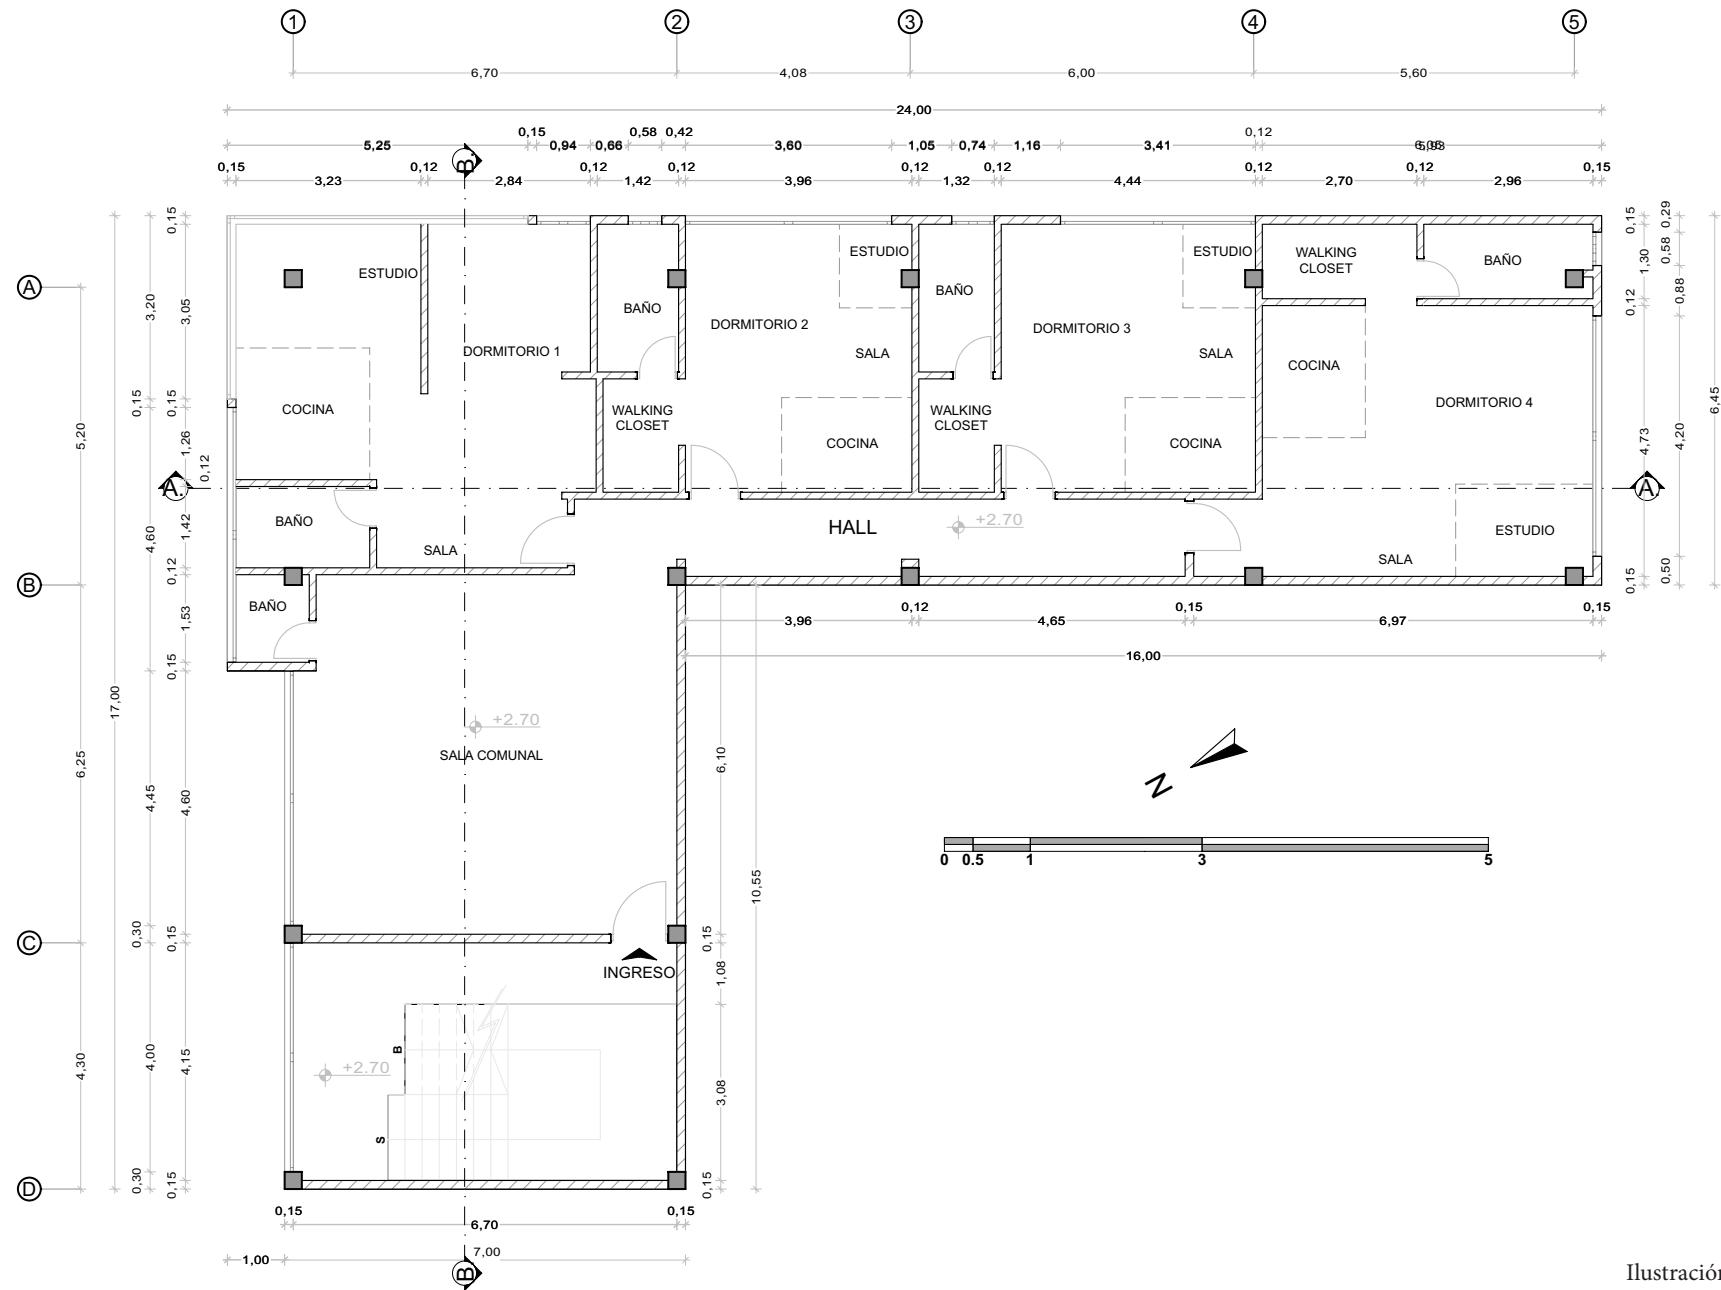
Autoría Jose Cruz. Planta de Distribución
